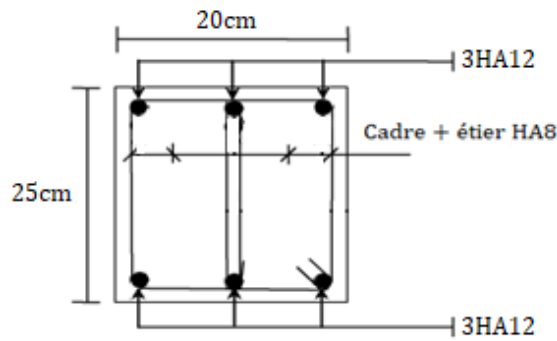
Schéma de ferrailage de la poutre de chaînage
